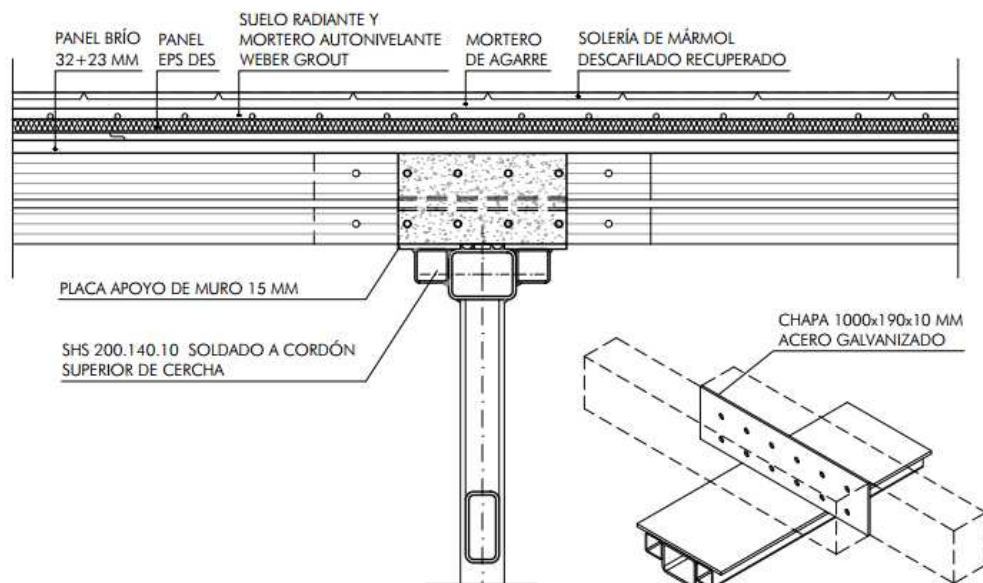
Detalle del apoyo de vigas de planta alta sobre cordón superior de la cercha
